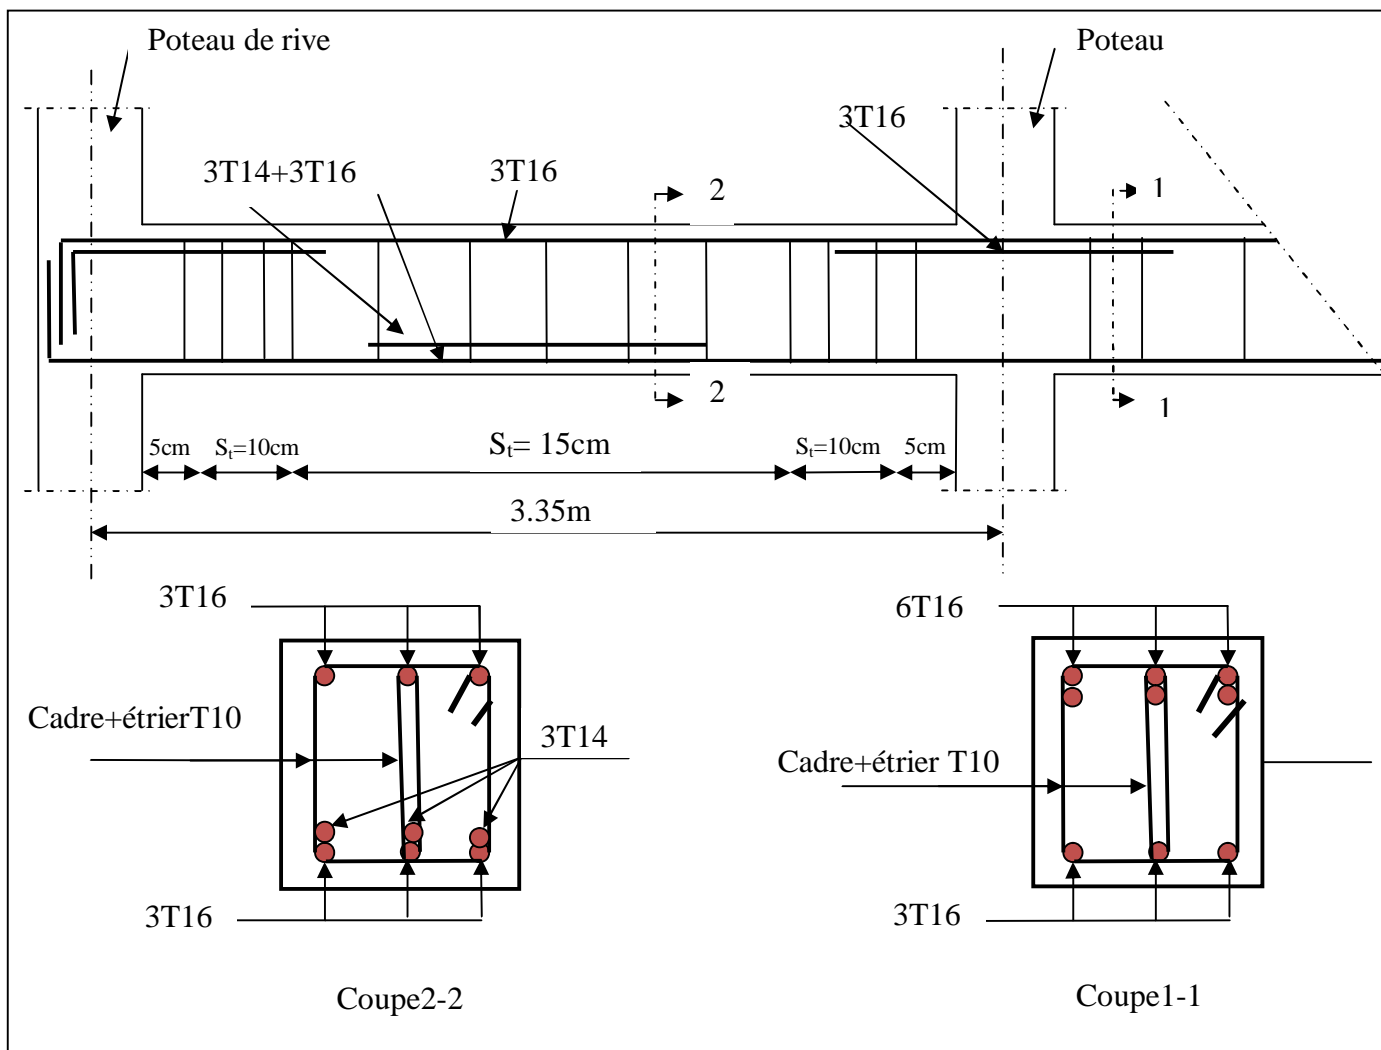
Schéma de ferrailage des poutres principales (étage courant)
